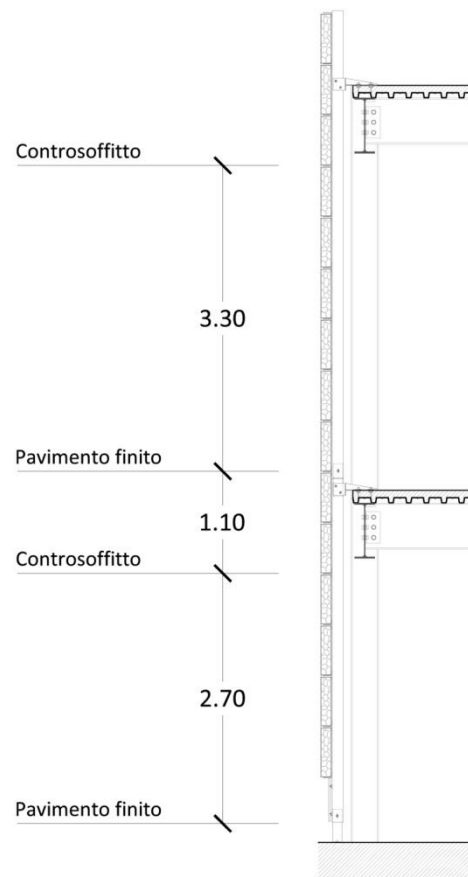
Sezione della facciata in gabion wall con le quote di interpiano
